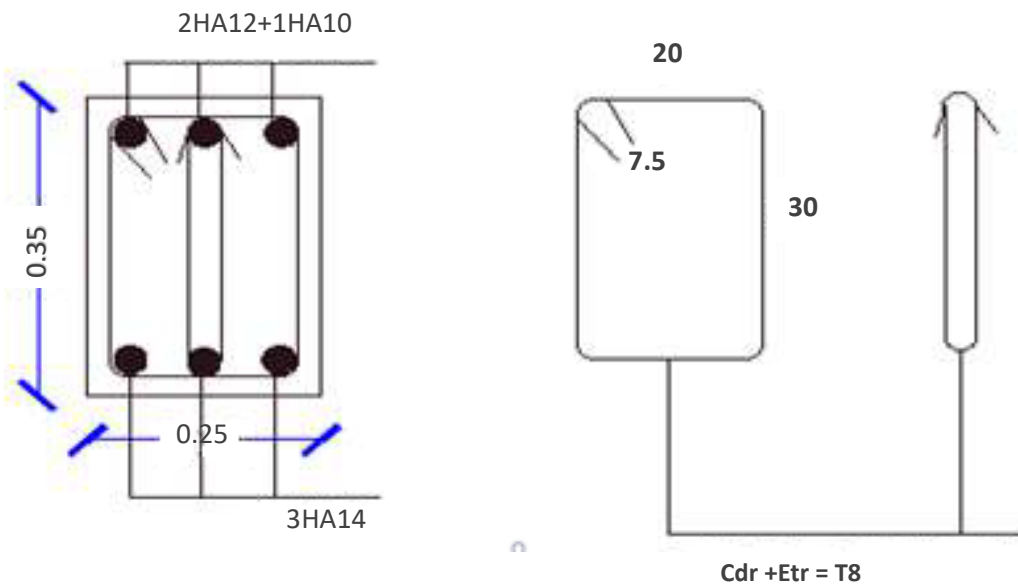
Schéma de ferrailage de la poutre chaînage.
